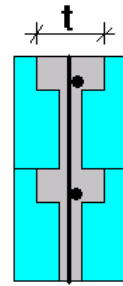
Vista en planta de un muro parcialmente relleno.
